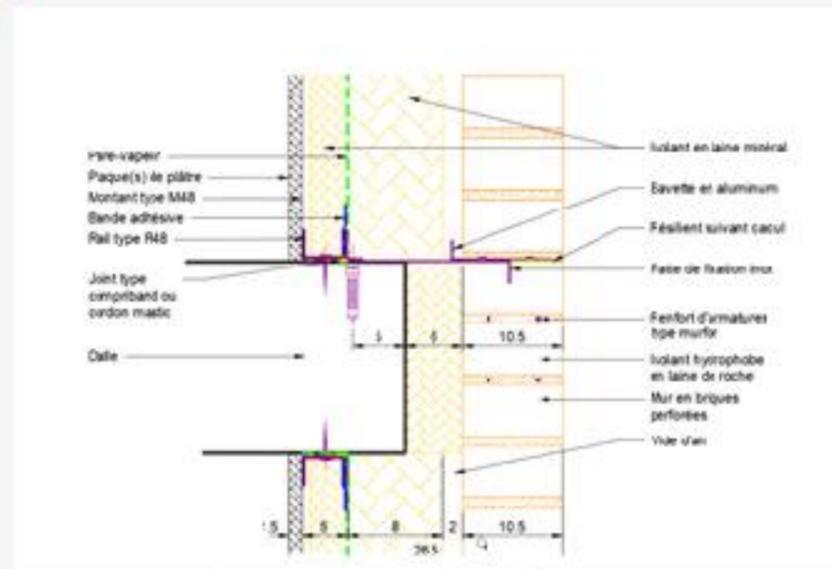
FIGURE: COUPE SUR MUR INTÉRIEUR ISOLÉ
